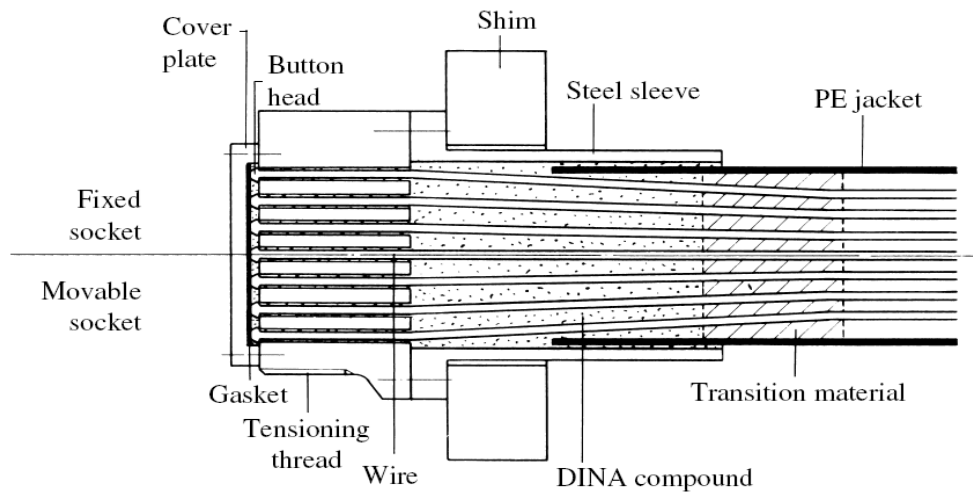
Dispositivo de anclaje HiAm (HiAm Anchor Socket)
